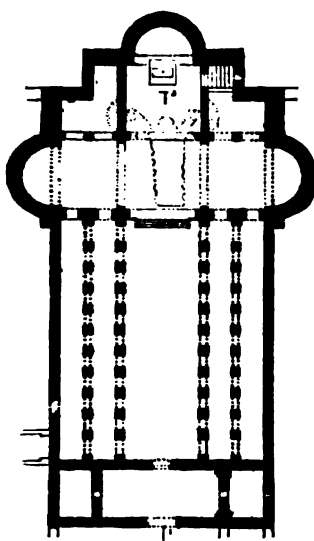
Grundriss der Marienkirche zu Bethlehem.
